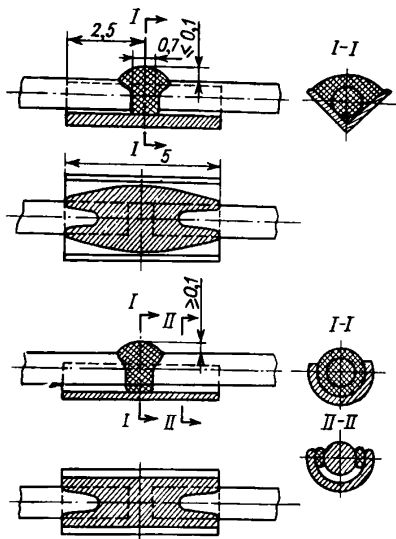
Сварка рабочей арматуры балок «ваннным» способом
